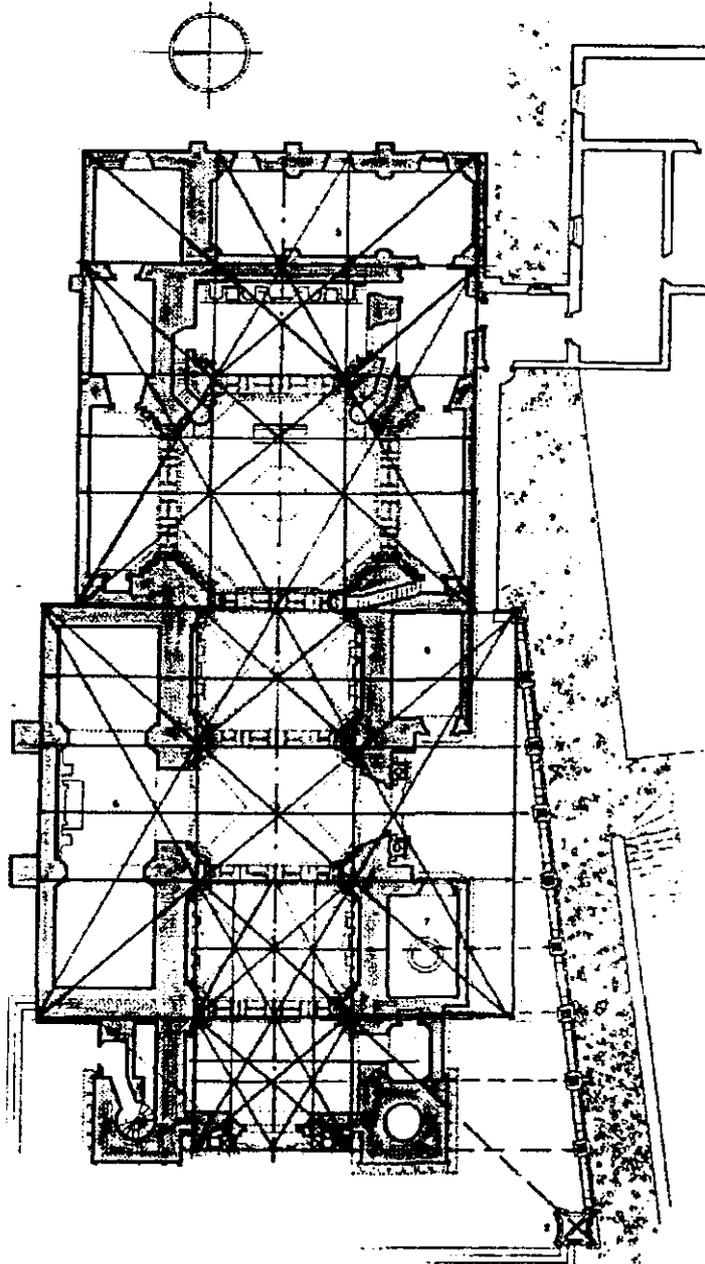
Trazo de la planta, de la parroquia de Santa Prisca, Taxco, Guerrero.
